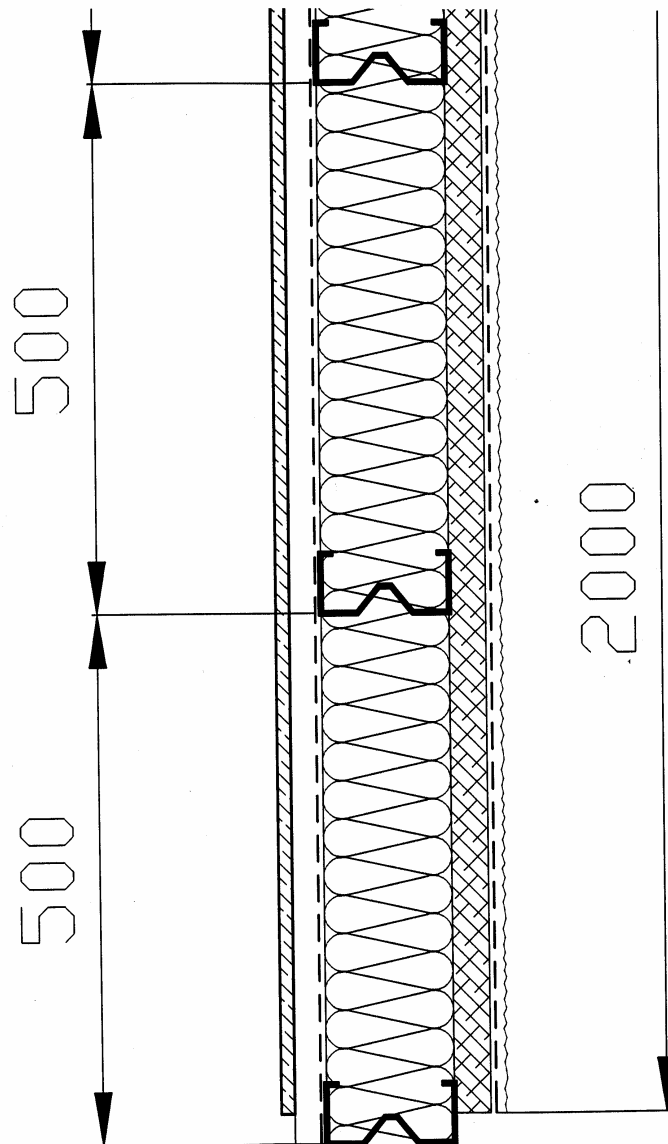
Coupe horizontale de mur avec Fibragglo et enduit hydraulique – Locaux non chauffés
